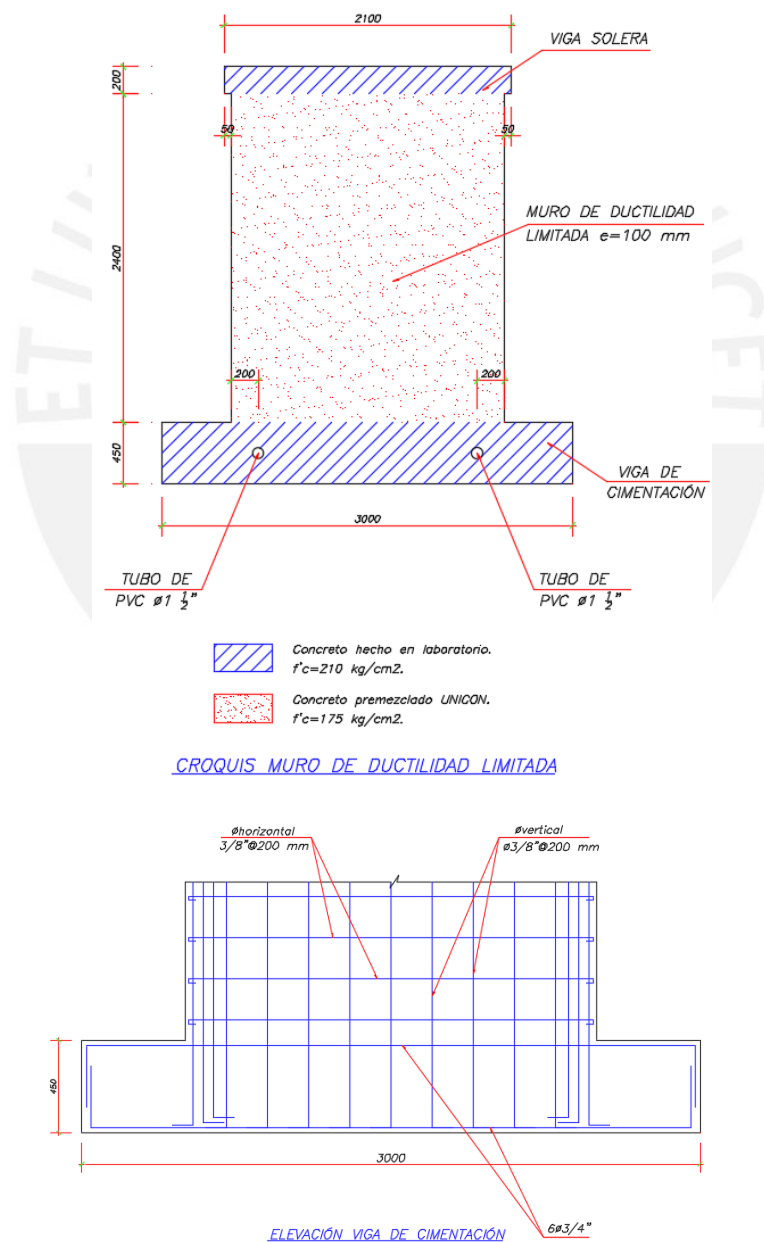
Croquis del muro de concreto y elevación de viga de cimentación
